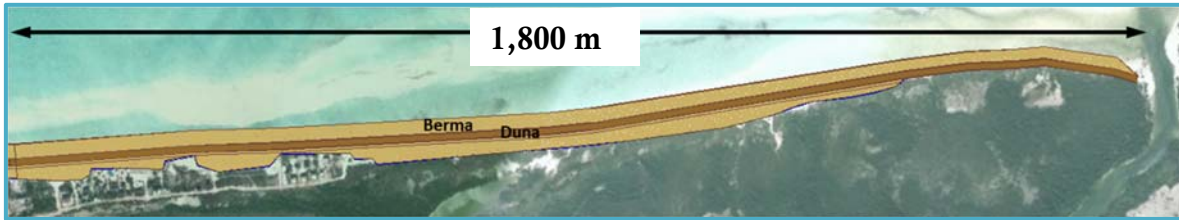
Plano de las obras a implementarse en la Zona Noreste.
